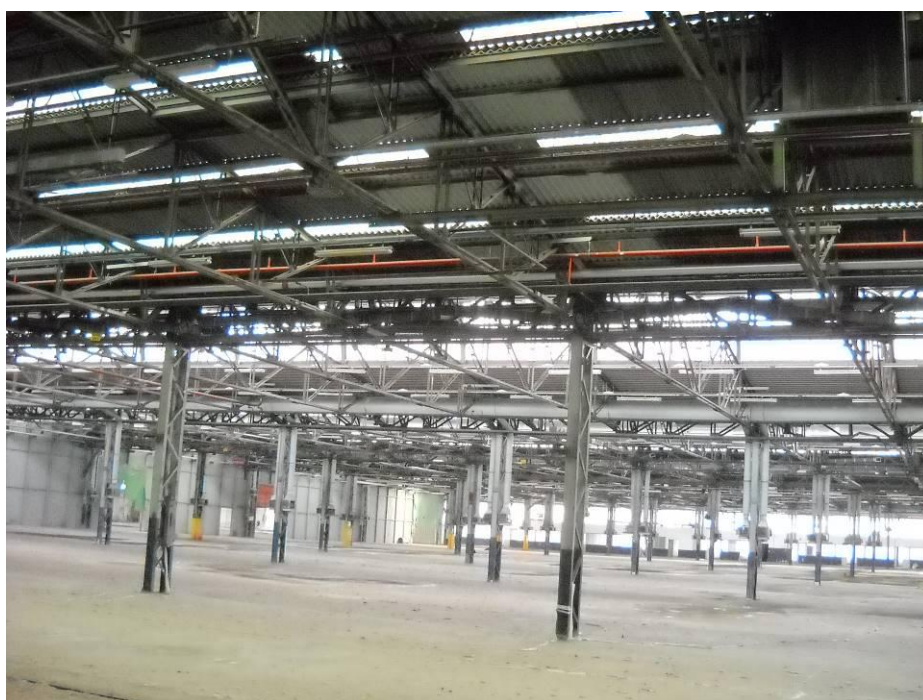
UMIA2 – porzione Capannone ex DAI - vista interna
